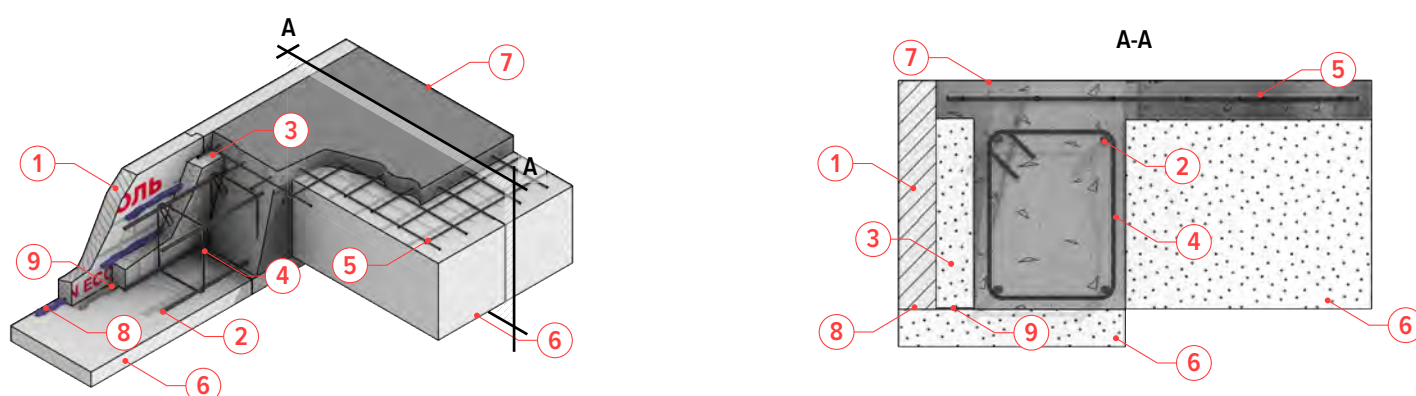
Железобетонный пояс в теле железобетонного перекрытия
